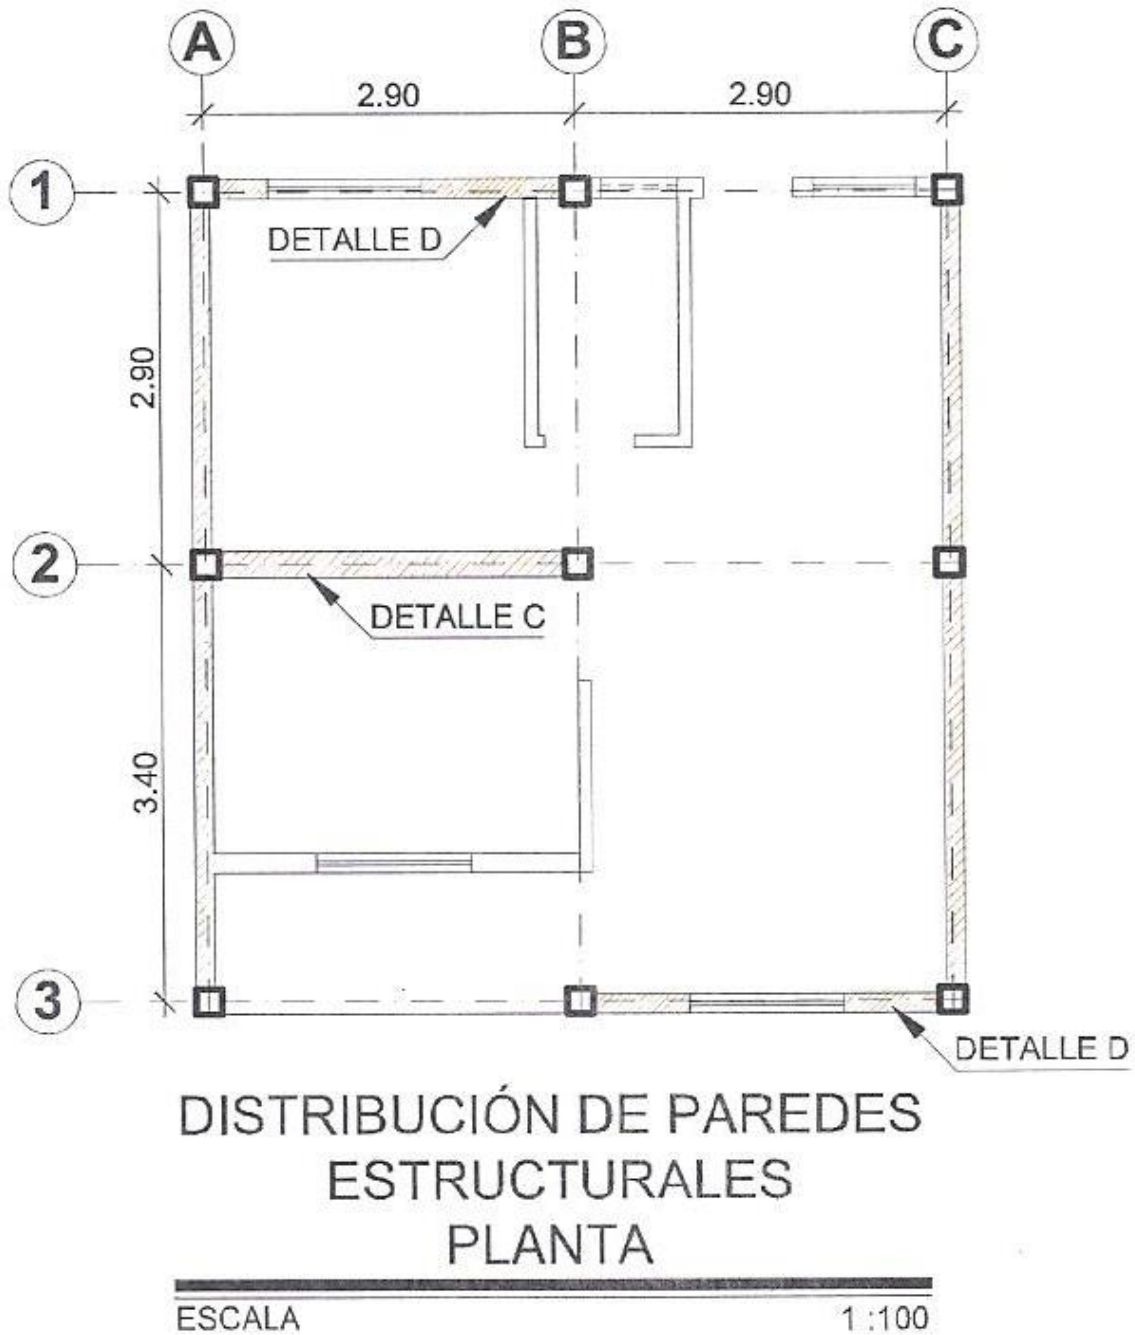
Detalle de la distribución de las paredes estructurales. Vista Planta
